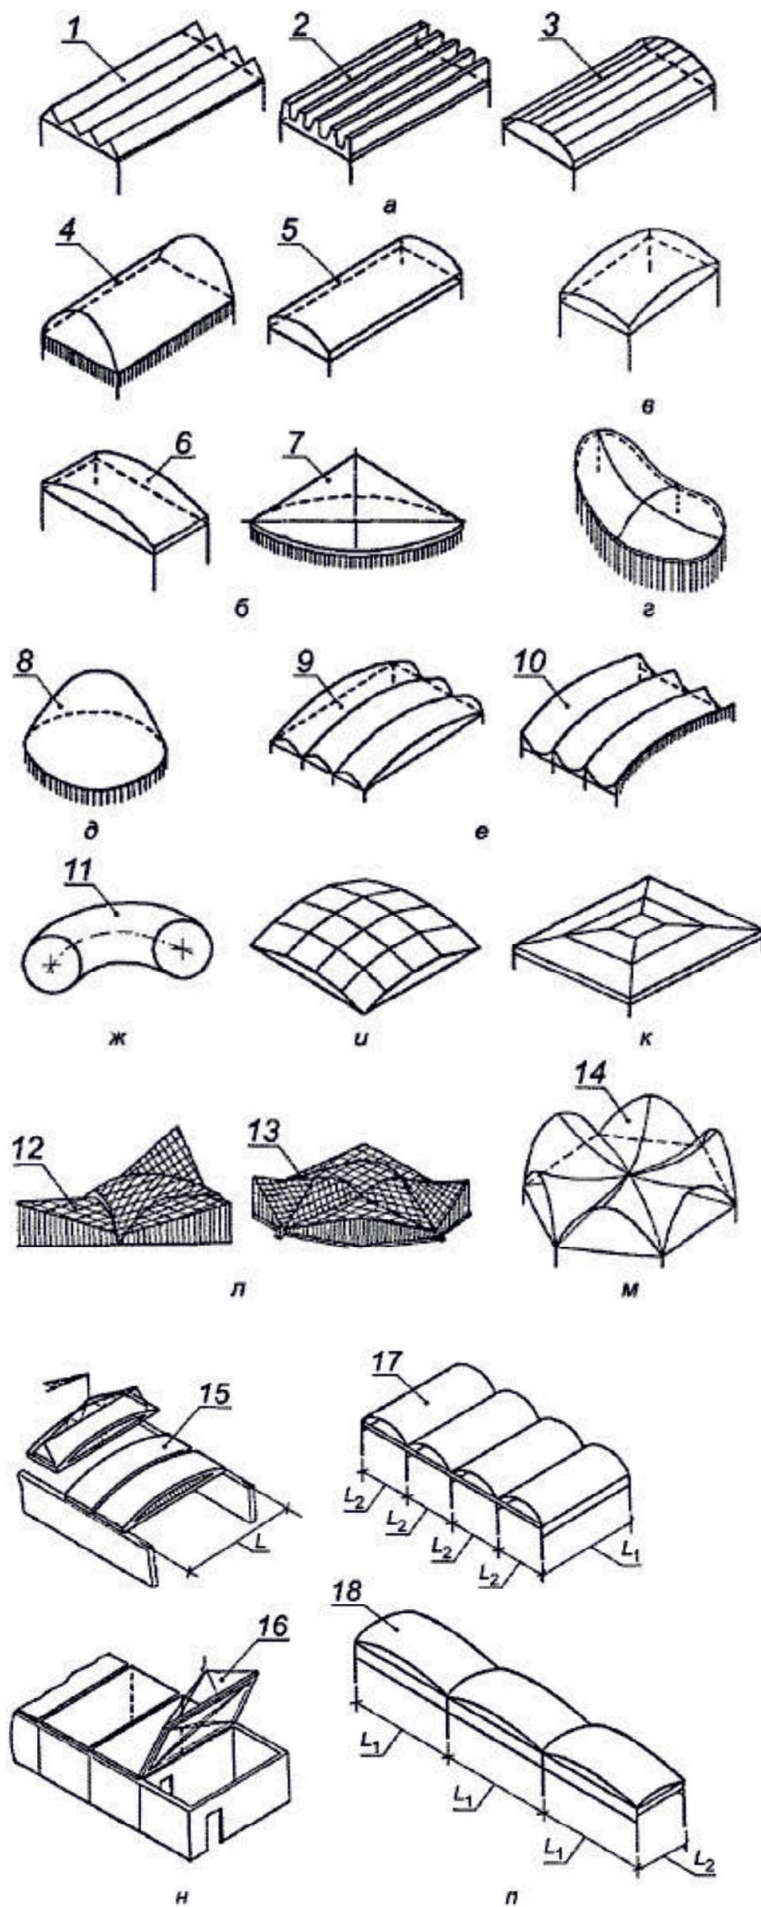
Очертания железобетонных тонкостенных пространственных конструкций
